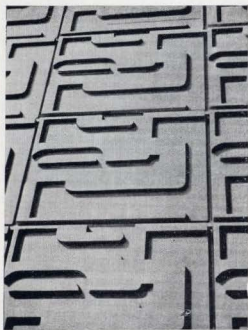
Пример ортогонального решения торцевого фасада здания. США
